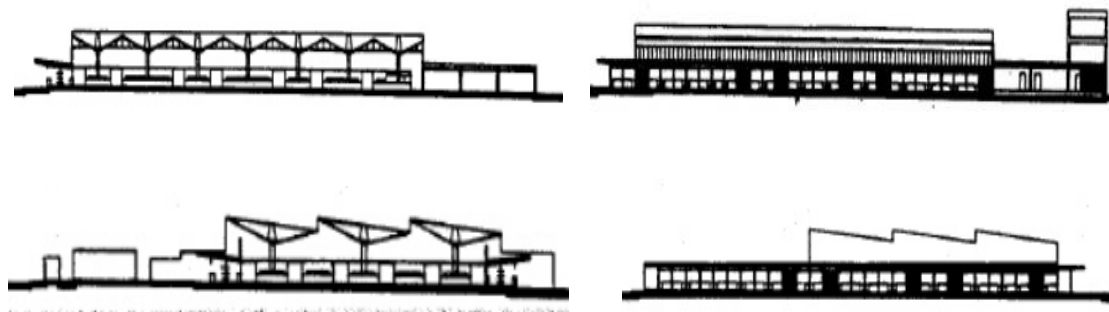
Cortes y fachadas del Mercado de Coyoacán
